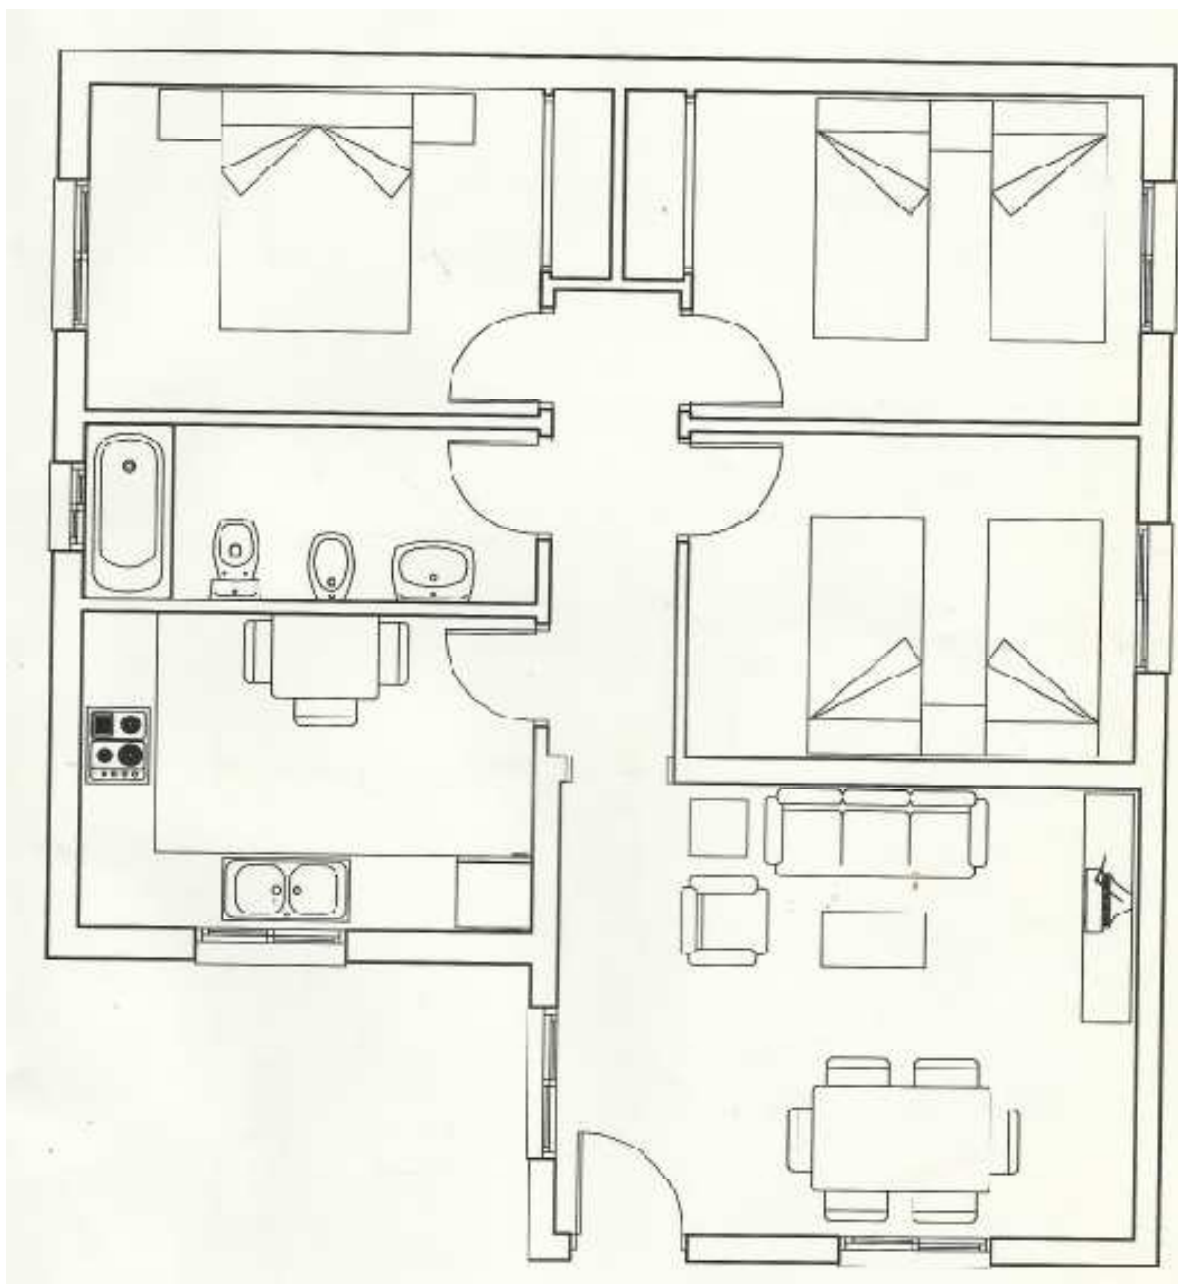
c) Plano nº 5.c): Vivienda unifamiliar rural aislada. Plano de distribución
